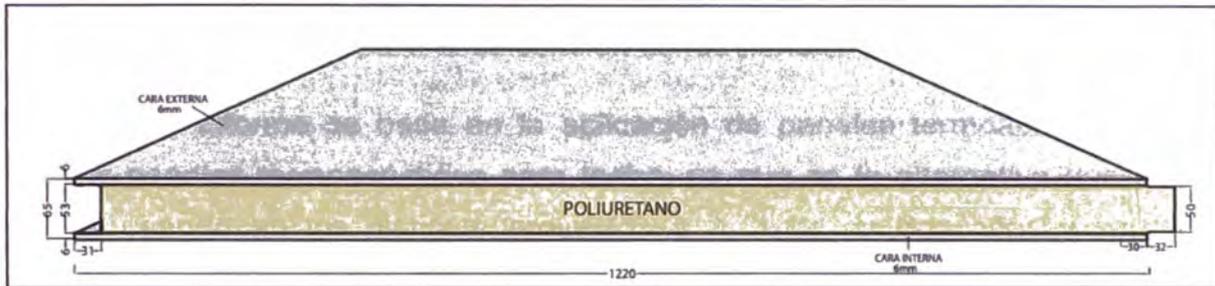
Se muestra el panel con núcleo de poliuretano y planchas de fibrocemento tipo sándwich.
